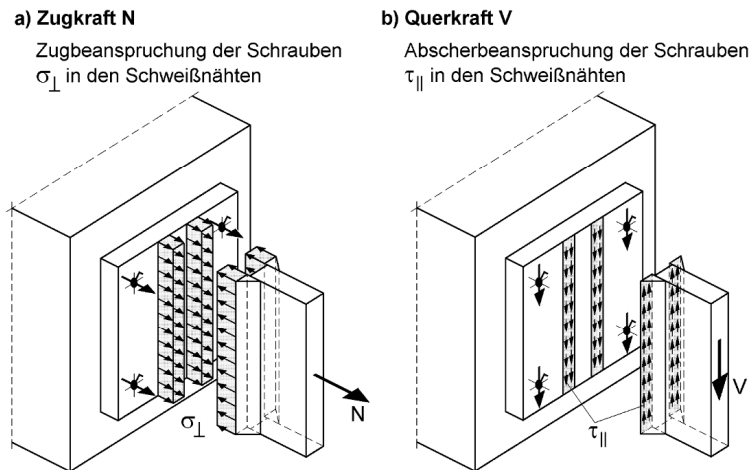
Zur prinzipiellen Beanspruchung von Schrauben und Schweißnähten
